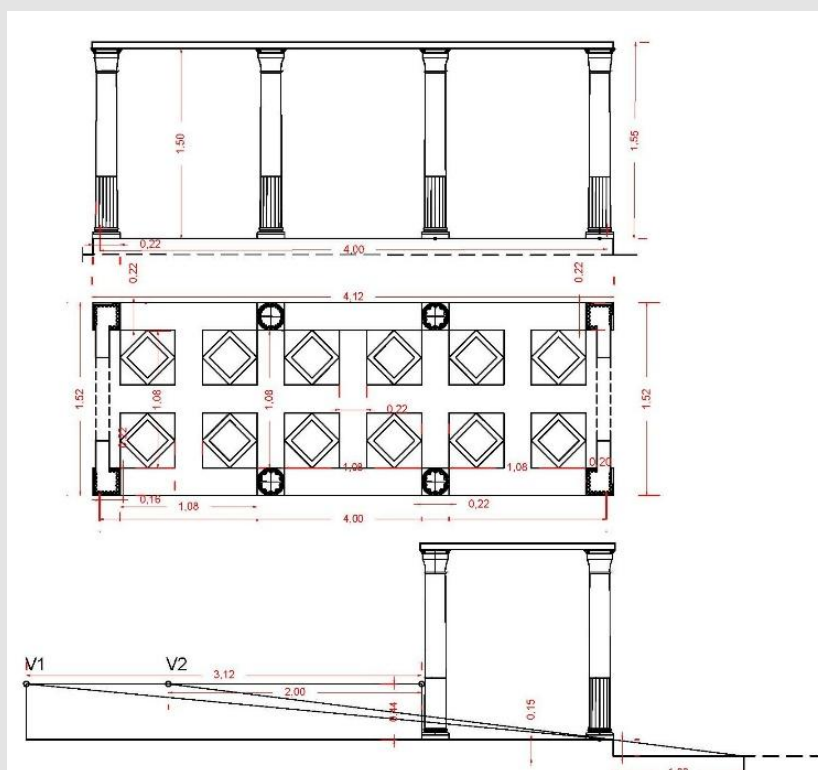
Pianta, prospetto e sezione della loggia con la posizione dei 2 punti di vista, alla distanza di br 3,12 e br 2.
